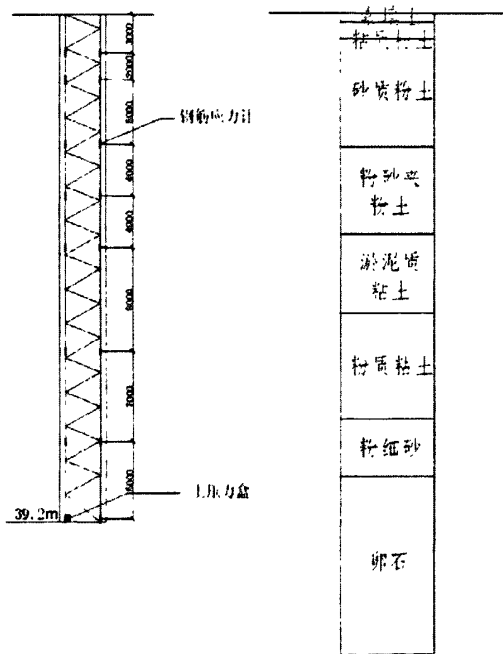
钢筋应力计和土压力盒埋设示意图及土层剖面
